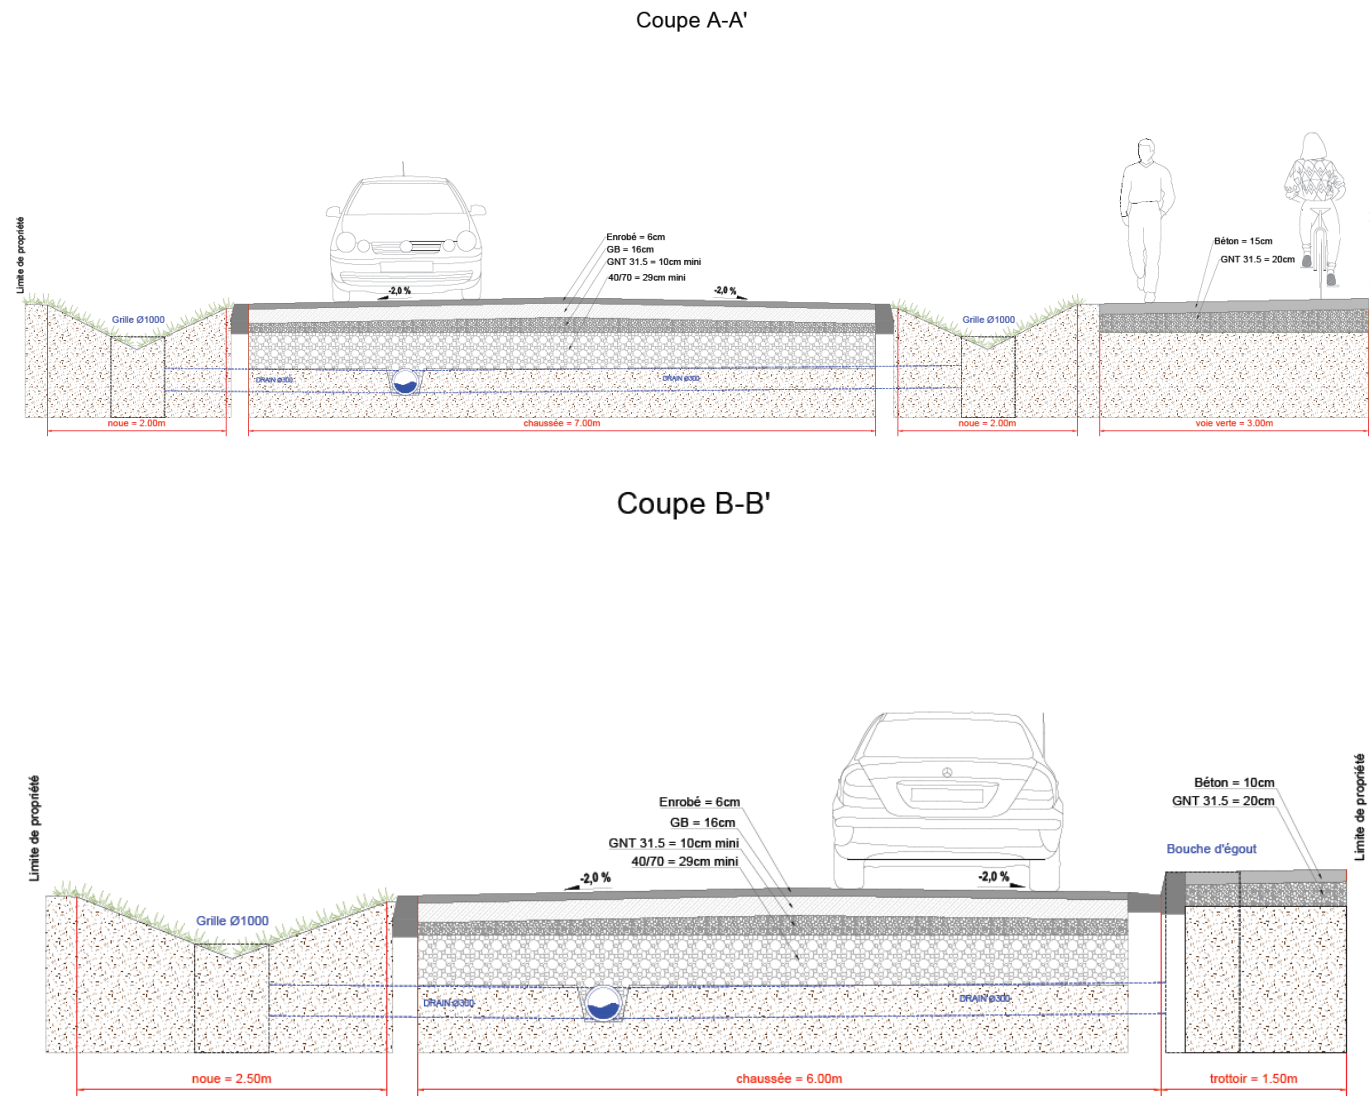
Coupe type de la voie principale (en haut) et de la voie secondaire (en bas)
